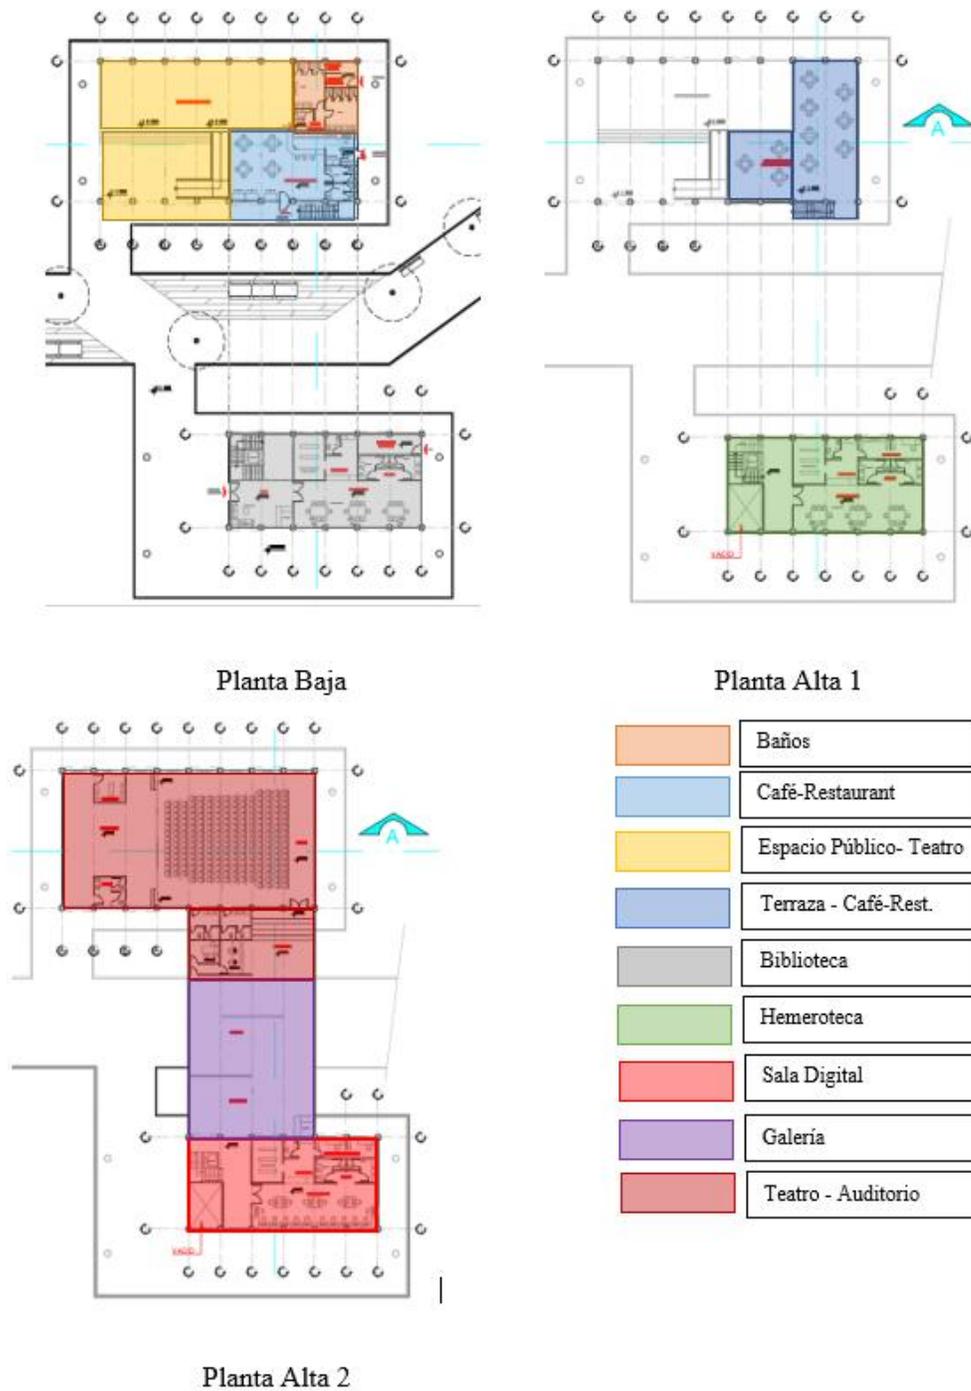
Planos Arquitectónicos Centro Cultural
